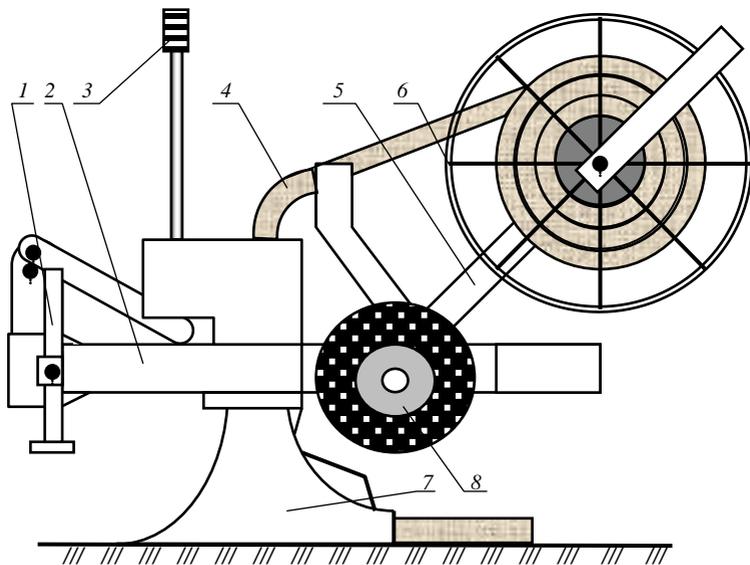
Схема оборудования МДИ: 1 – дополнительная опора; 2 – рама; 3 – приемник лазерного луча; 4 – дренажная труба; 5 – стойка; 6 – барабан; 7 – нож; 8 – колесная опора
